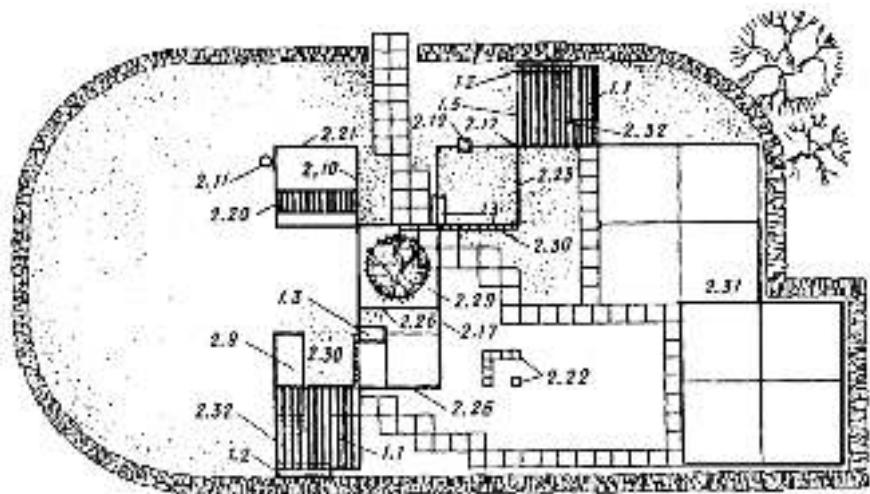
Планировка игровой площадки дошкольной группы (4-5 лет) (ЦНИИЭП учебных зданий)
